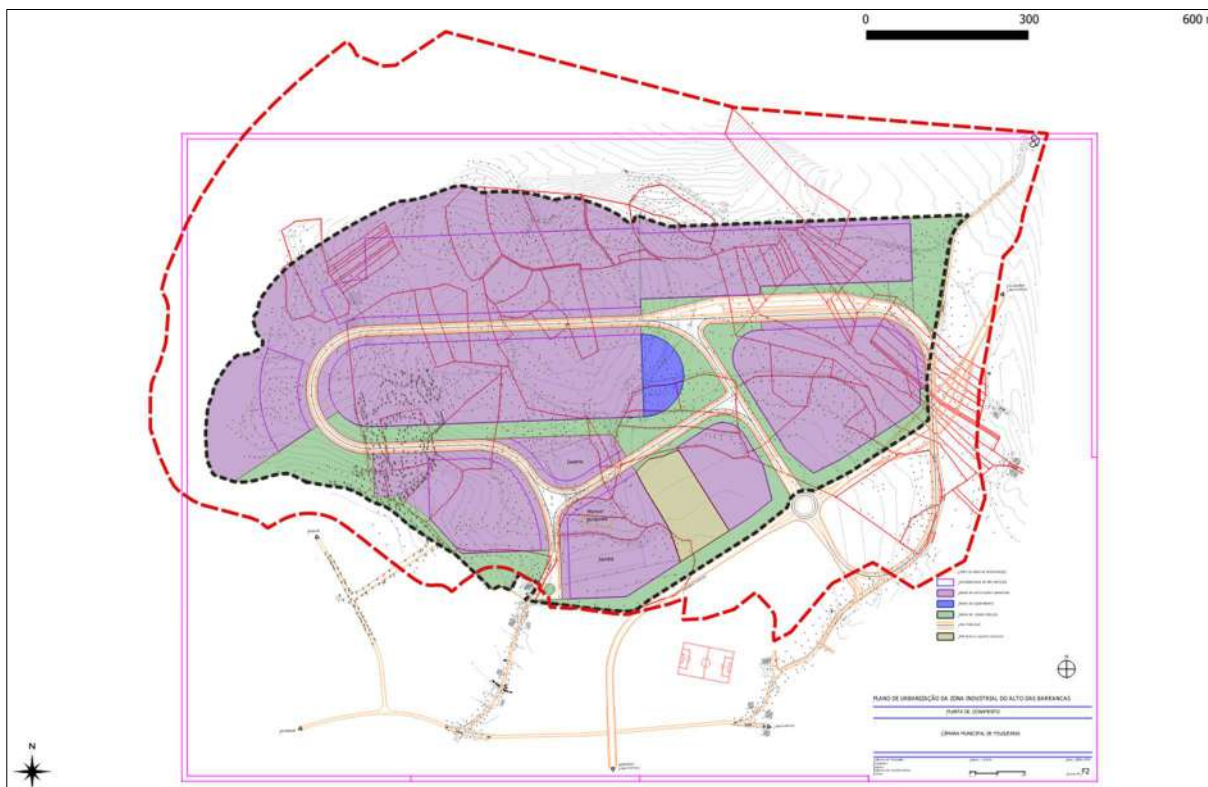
Planta de Zonamento do Plano de Urbanização da Zona Industrial do Alto das Barrancas face à área de intervenção proposta para a Área de Acolhimento Empresarial do Alto das Barrancas
